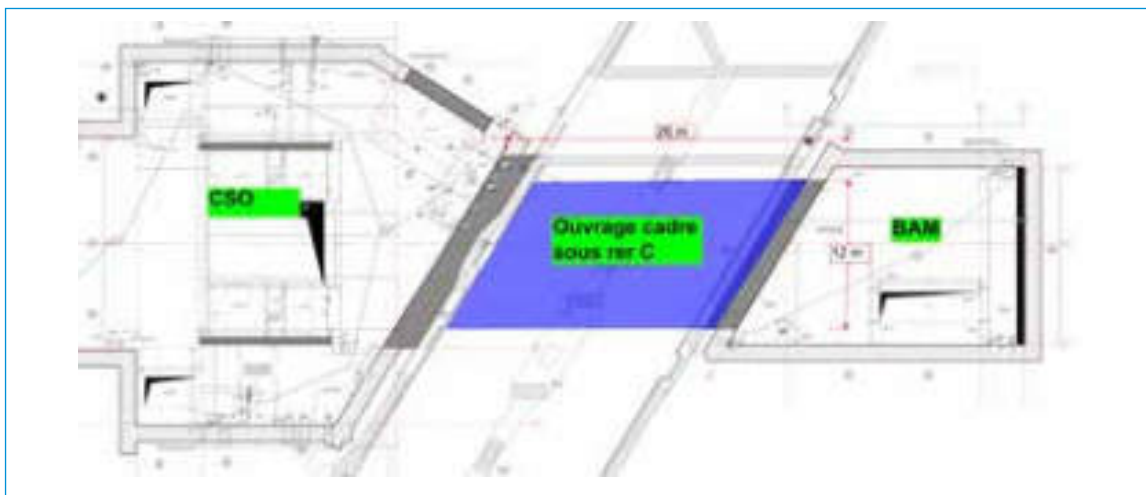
Vue en plan de l'ouvrage cadre sous le RER C - Plan view of the framework structure under RER C
